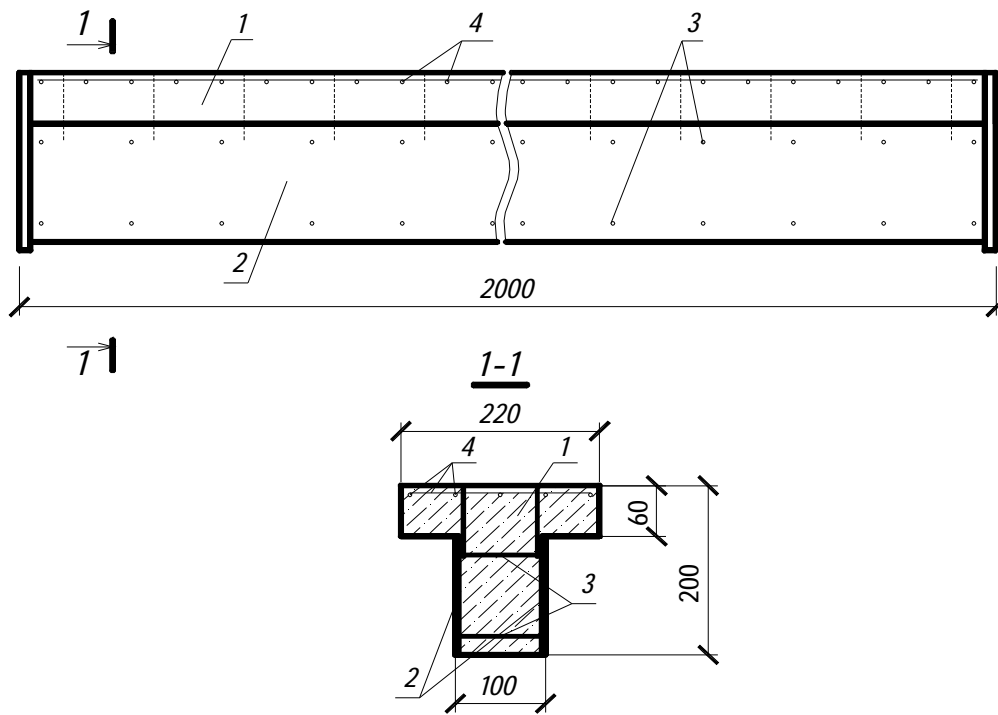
Таврова сталезалізобетонна балка зі стрічковим армуванням
